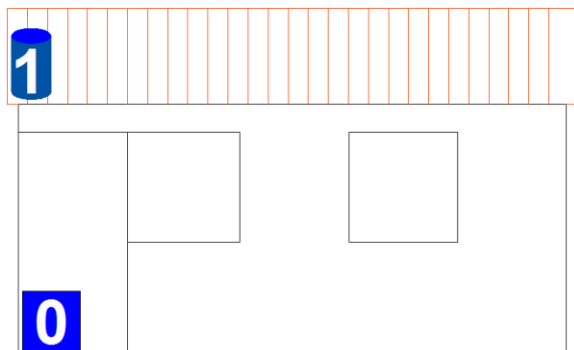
Ubicación acelerómetros. Vivienda sin Techo Verde. Vista: Perfil Fachada Norte
